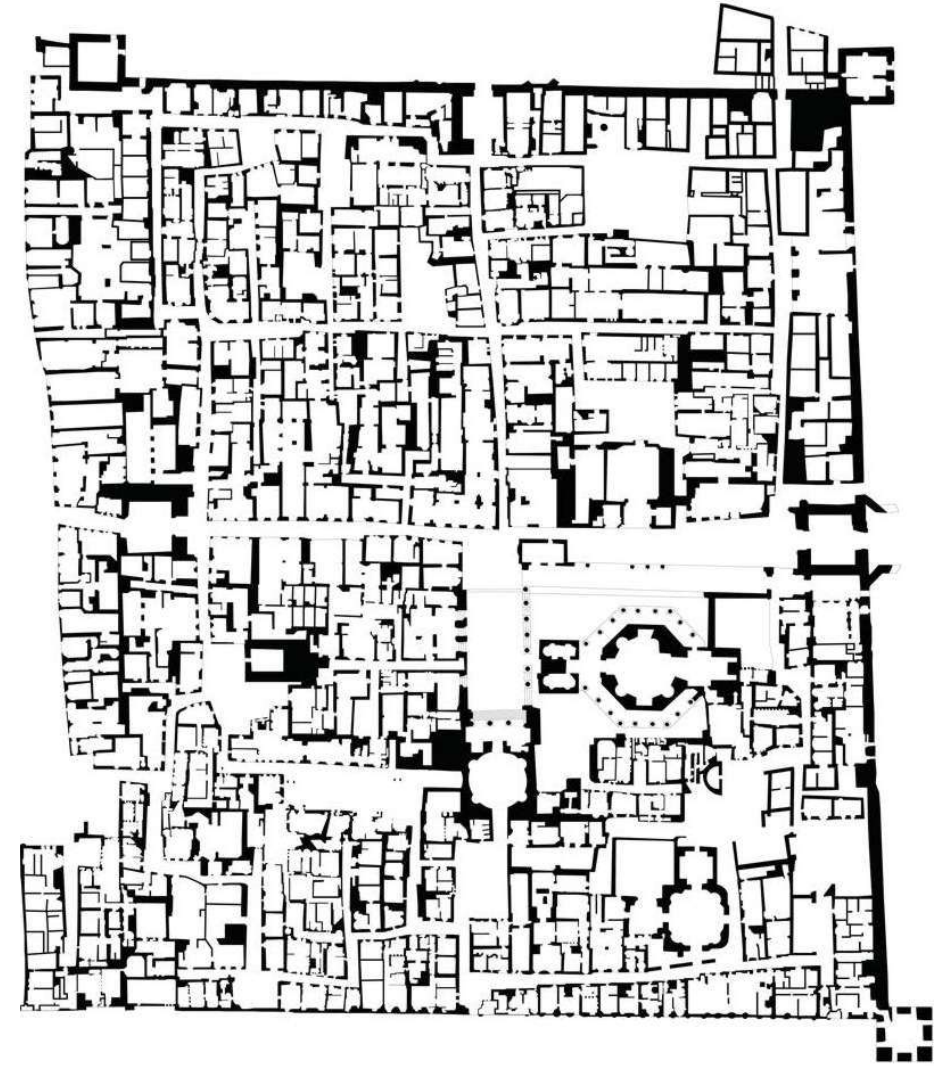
Grundriss Diokletianspalast 300 n. Chr., ETH Zürich, Studio Adam Caruso, Edited by Alex
